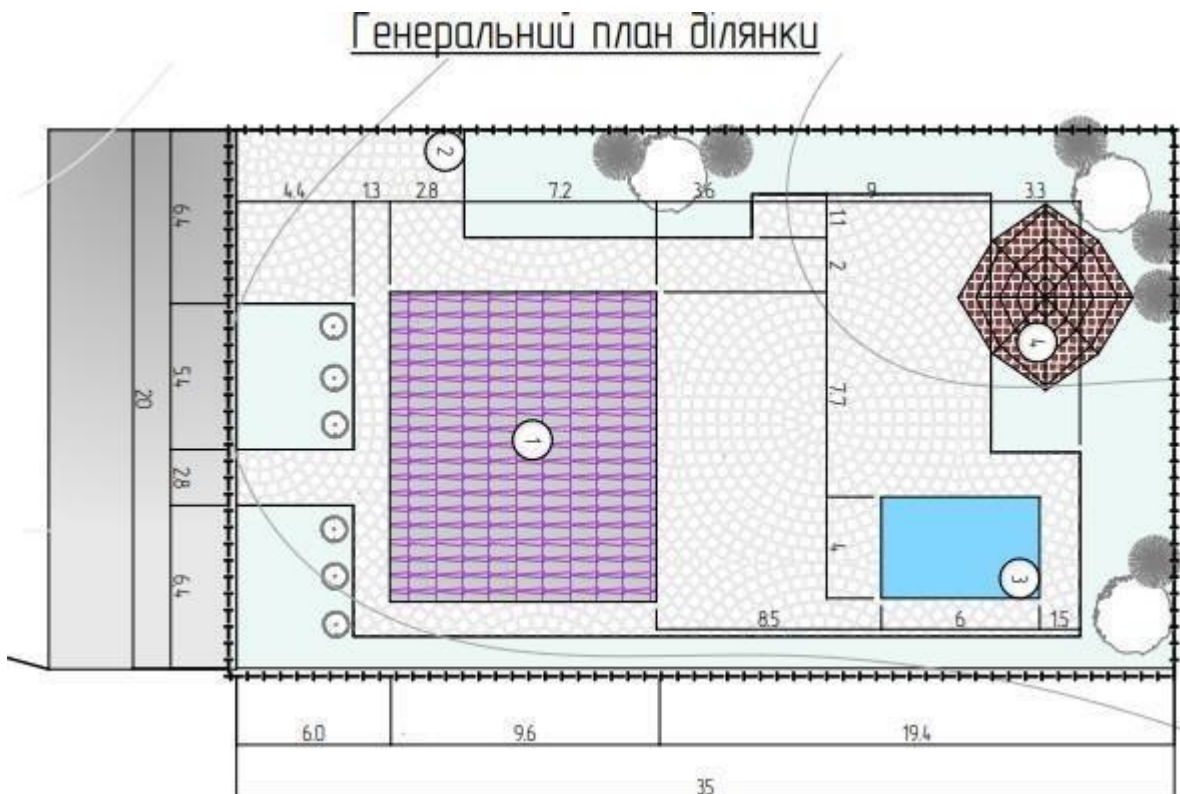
Генеральний план участка з висотними відмітками будівлі
